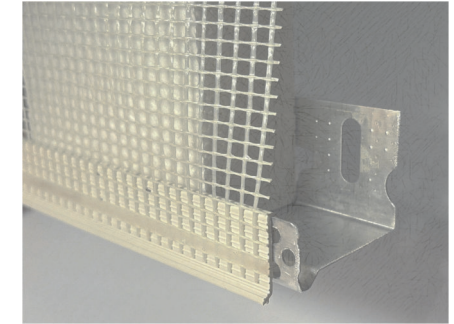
Perfil clip goterón para el encuentro mortero perfil arranque metálico. Fuente: Marta Epelde.
